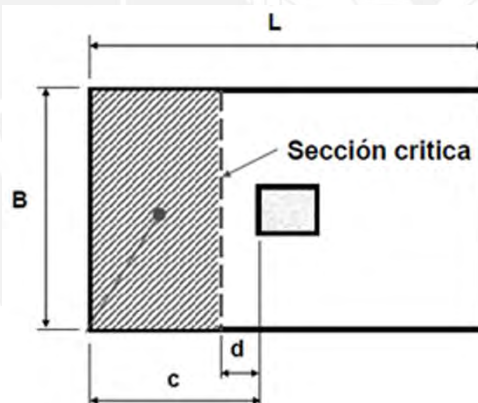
Sección de análisis para verificación por corte en zapatas aisladas
